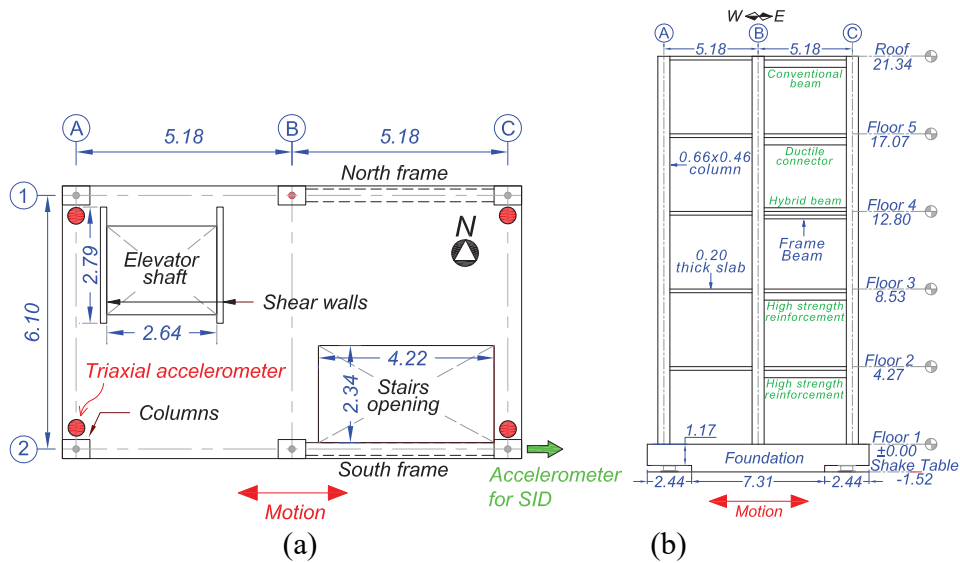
(a) Vista en planta. (b) Vista en elevación. (Dimensiones en metros). Fuentes: (Astroza, et al., 2015).
